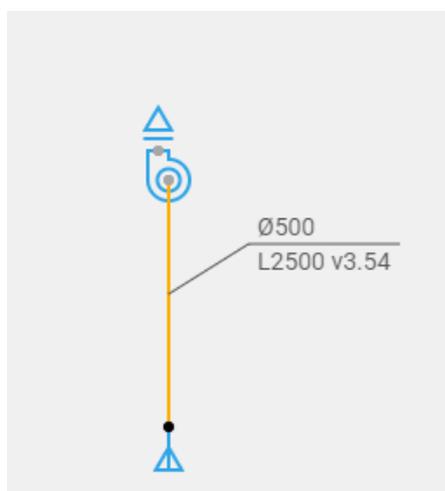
Фрагмент схеми вентиляції В-36\В-46 (витяжка) для аеродинамічного розрахунку
